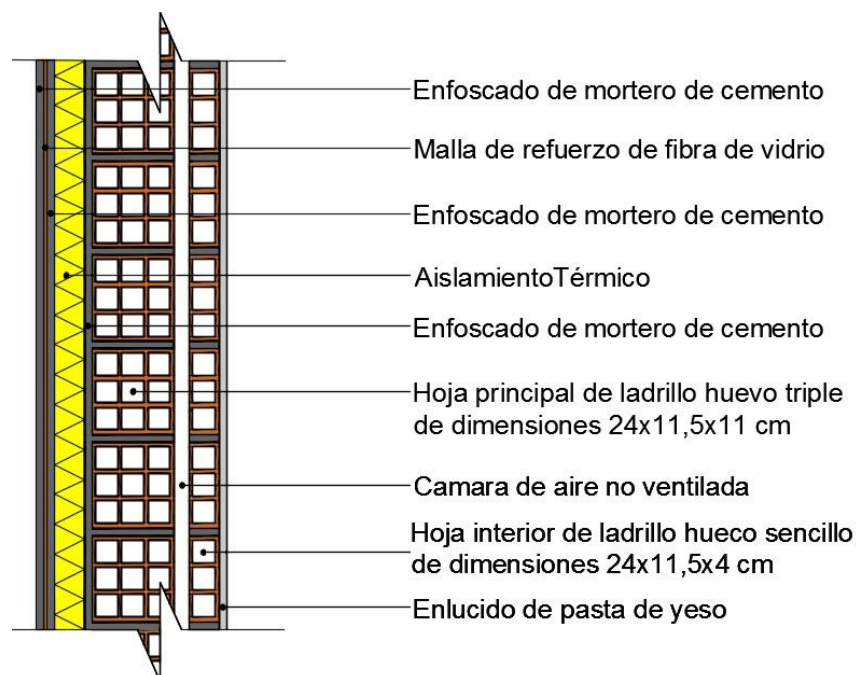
Sección constructiva del sistema SATE de la fachada principal del edificio
